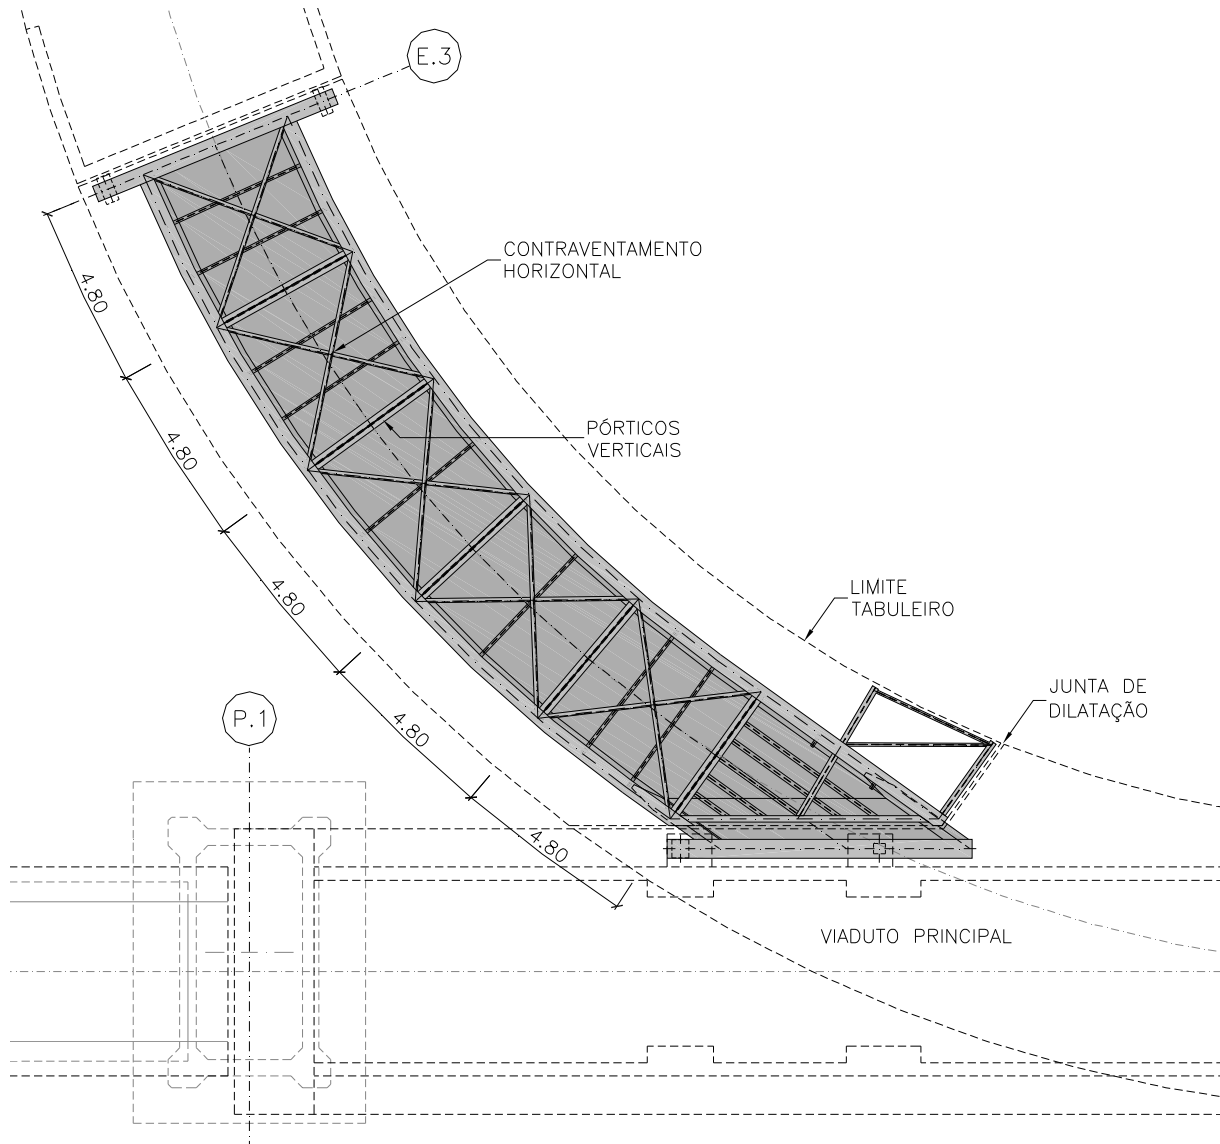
Planta do caixão metálico do viaduto de acesso do lado do Túnel
